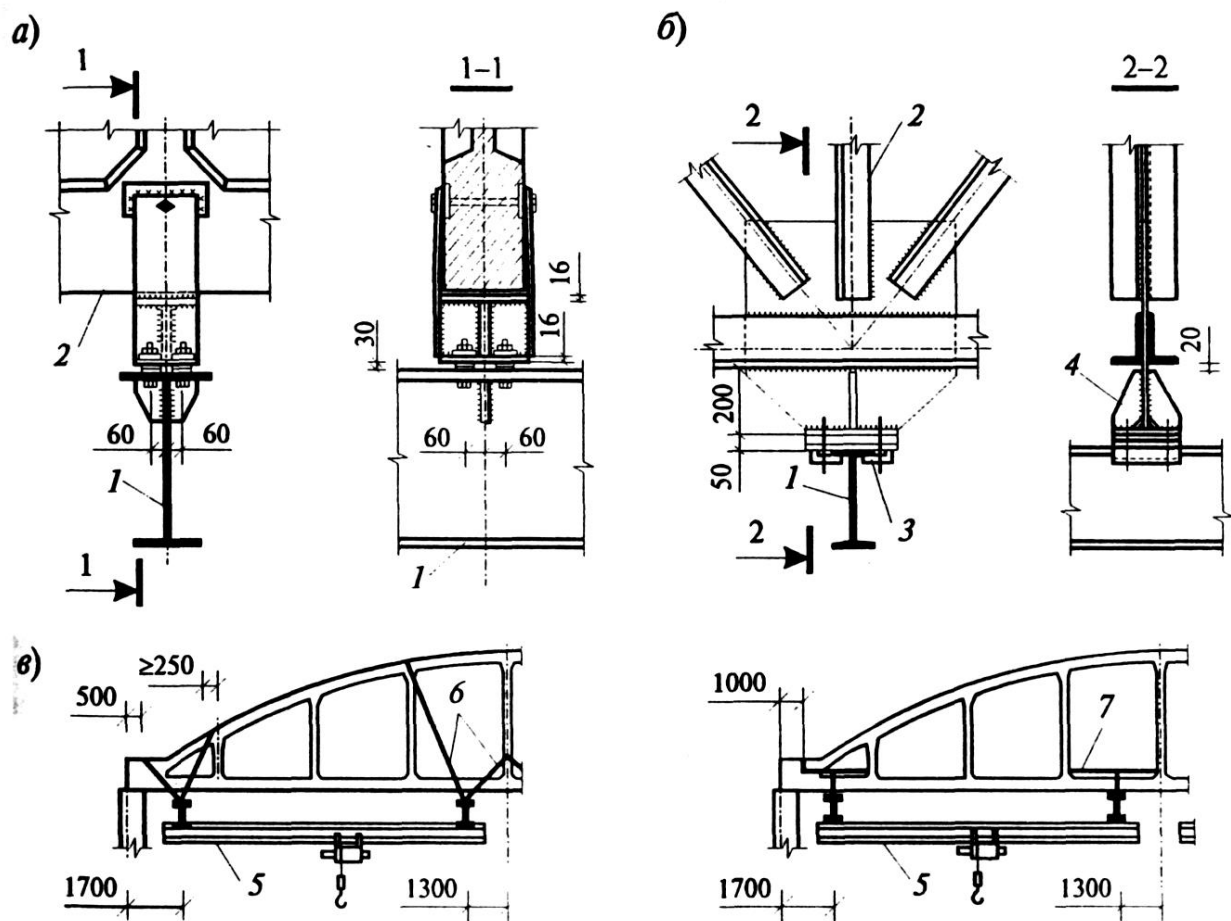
Способы крепления подвесных путей к стропильным конструкциям:
